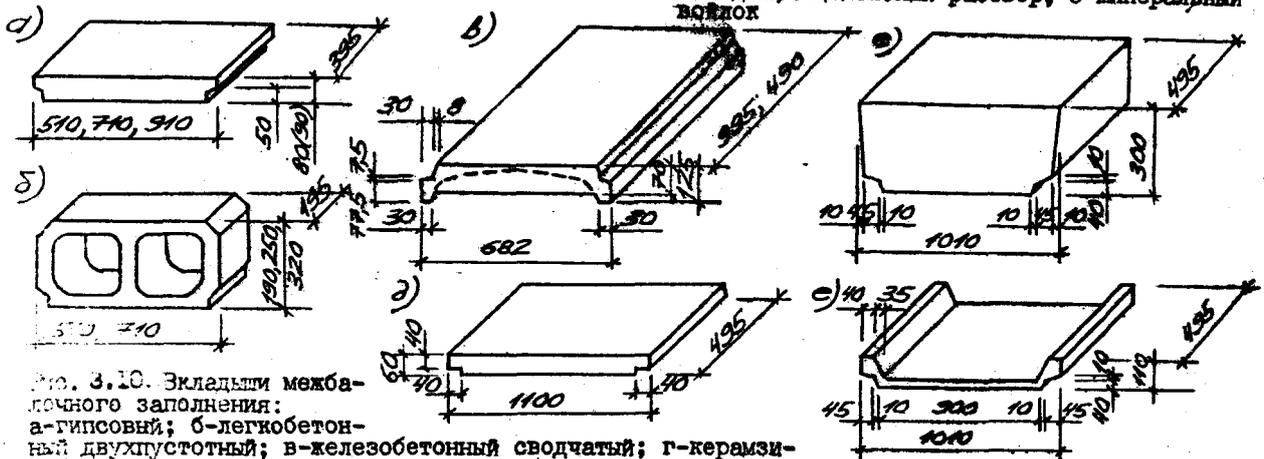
Вкладыши междуэтажного заполнения: а-гипсовый; б-легкобетонный двухпустотный; в-железобетонный сводчатый; г-керамзитобетонный сплошного сечения; д-железобетонная верхняя плита; е-железобетонный корытного сечения
